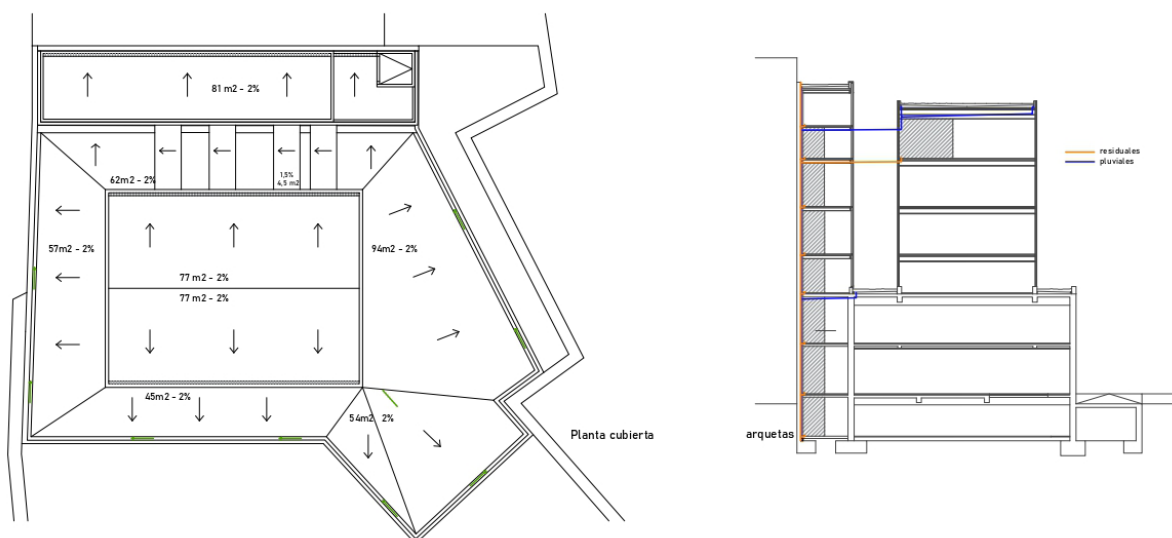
Esquema general de saneamiento Fuente: Elaboración propia
